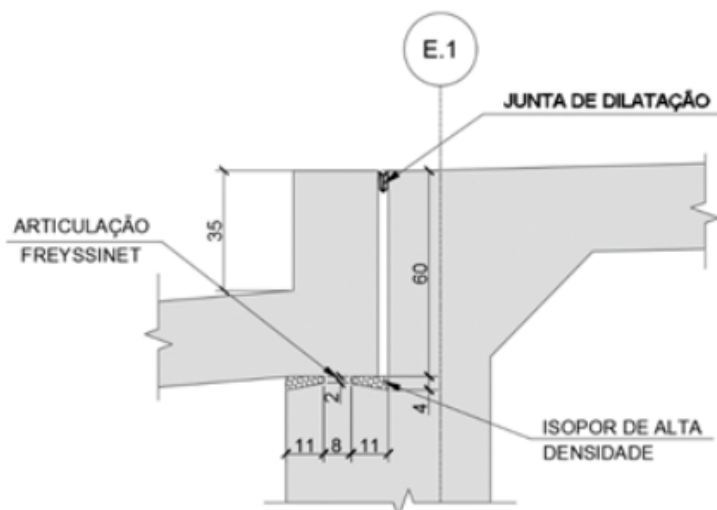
Detalhe do apoio utilizado na ponte tipo Freyssinet.
